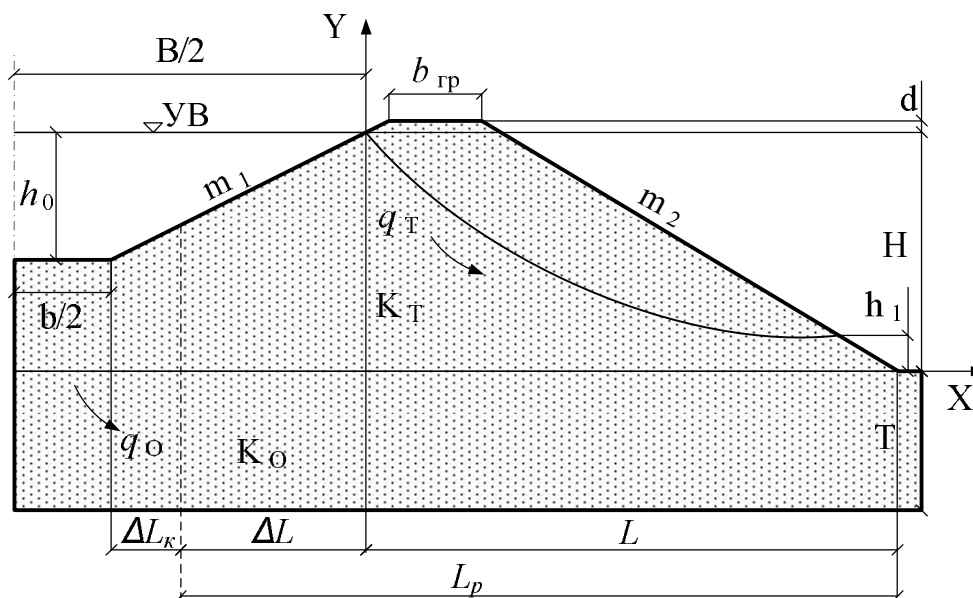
Расчетная схема канала в насыпи на водопроницаемом основании
